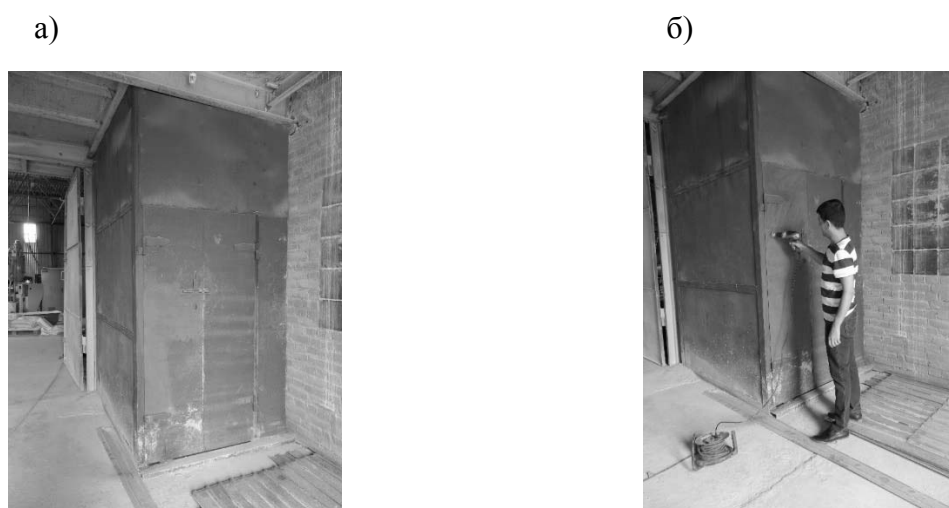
Внешний вид металлоконструкций шахты грузового лифта (а) и удаление продуктов атмосферной коррозии (б)
